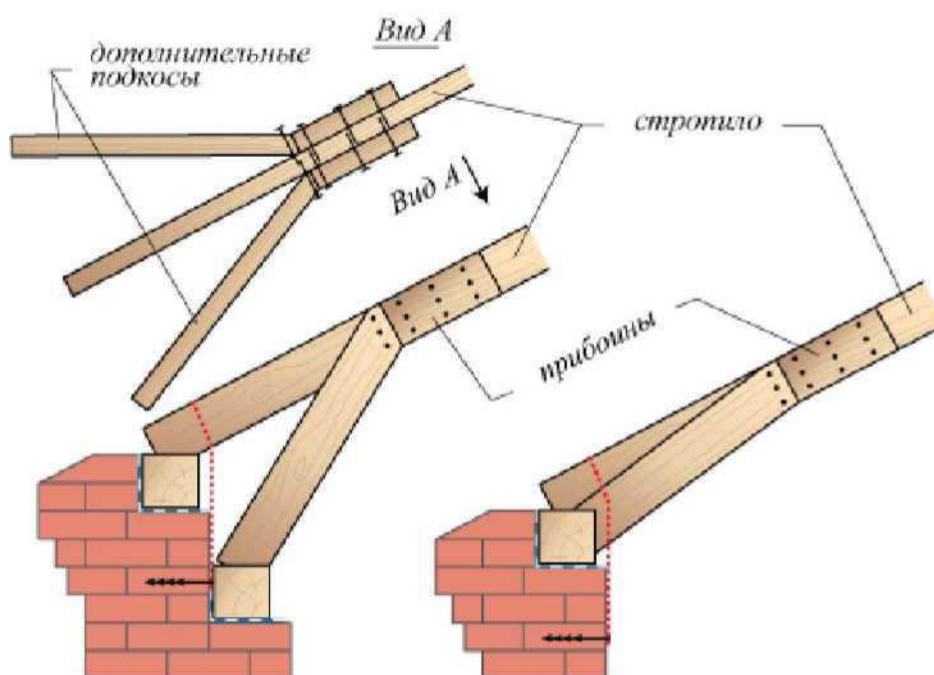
Усиление низа стропильной ноги установкой дополнительных подкосов
